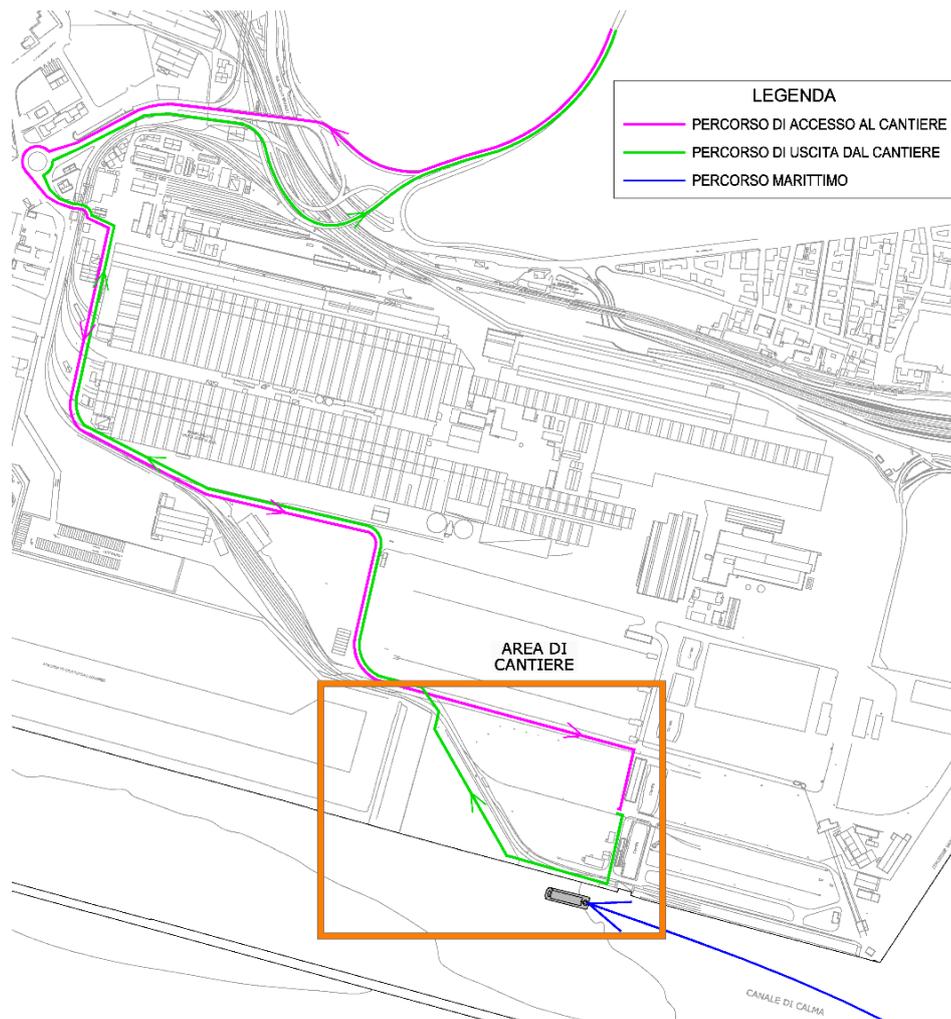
AREA DI CANTIERE EX ILVA – PLANIMETRIA PERCORSI DI ACCESSO/USCITA
